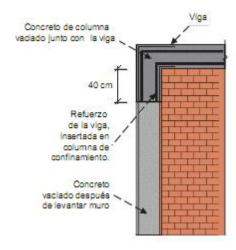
Detalles del acero de vigas y columnas en el segundo piso
